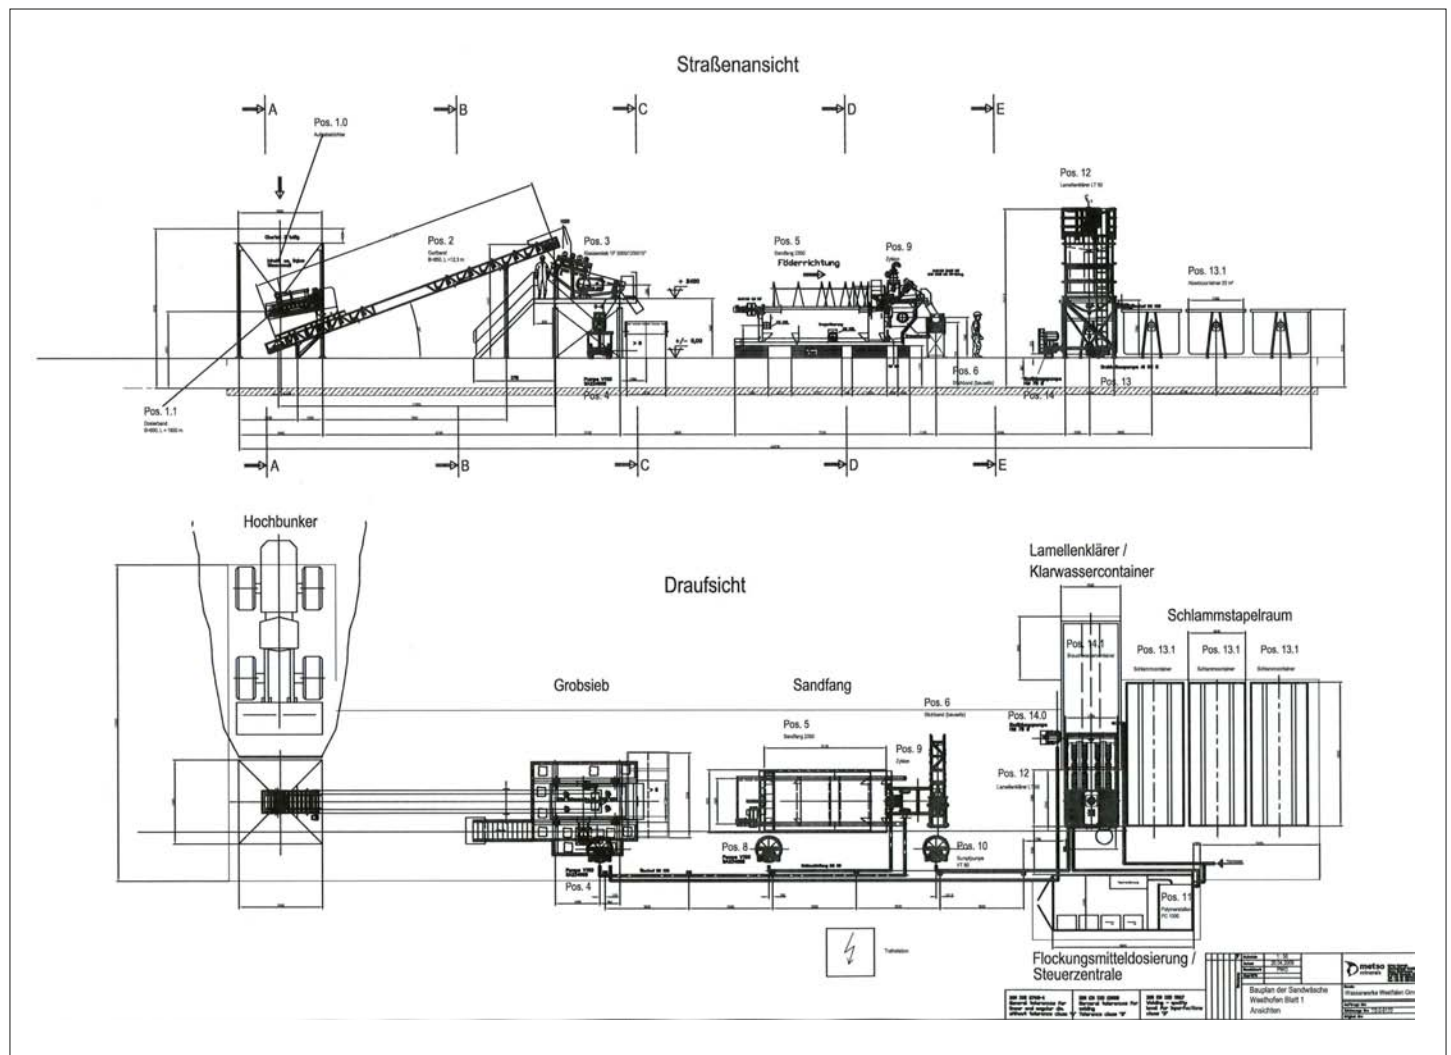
Sandwäsche Westhofen: Draufsicht und Schnitt
